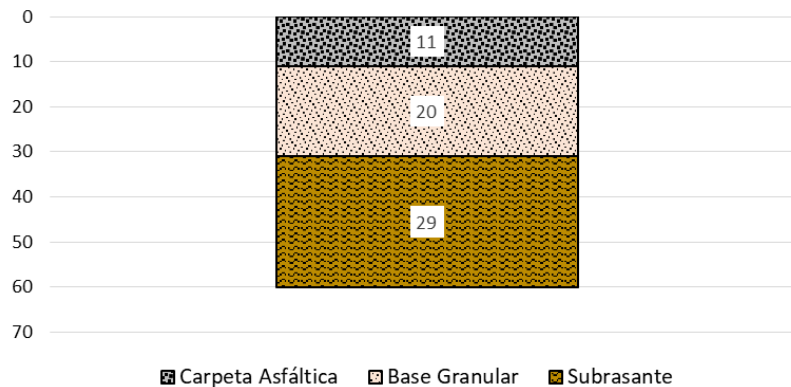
Estructura de Pavimento Flexible Propuesta
